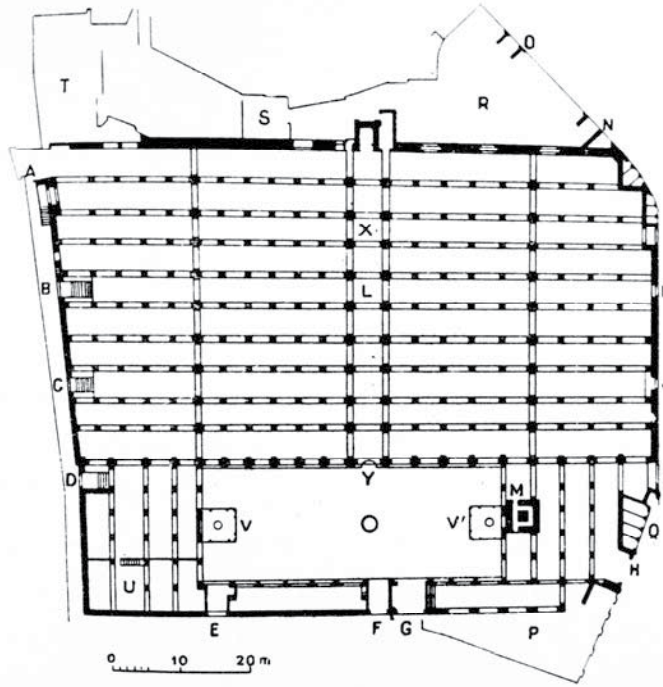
جامع جزائر بني مزغنة، مسقط أفقي، عن:
